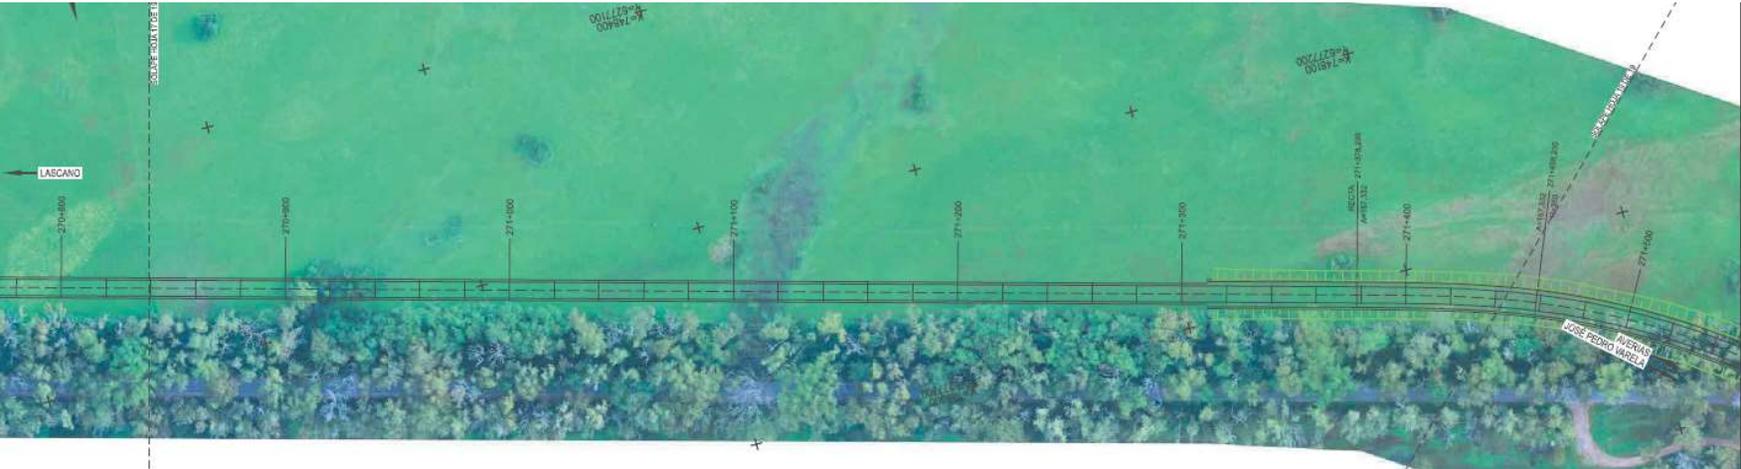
Extracto de plano de planta del nuevo tramo (2)
